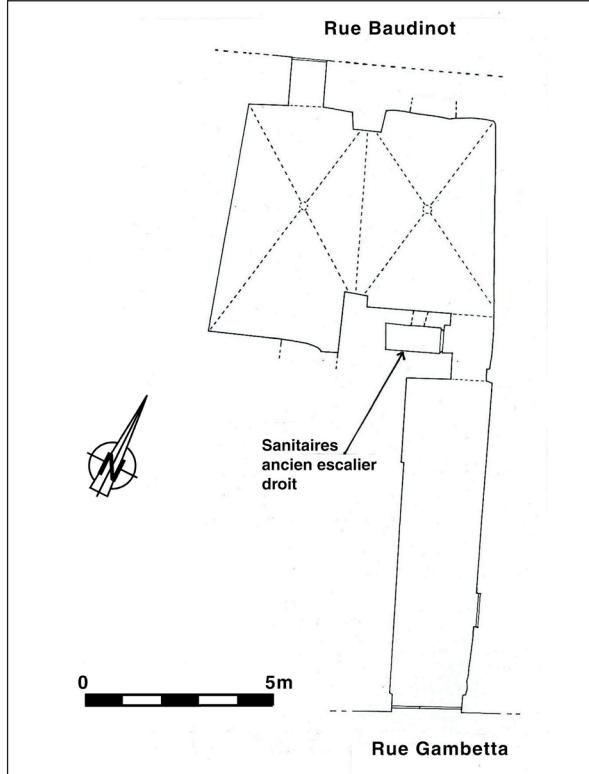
plan des caves gothiques du n° 9 rue Gambetta (relevés F.C.)
